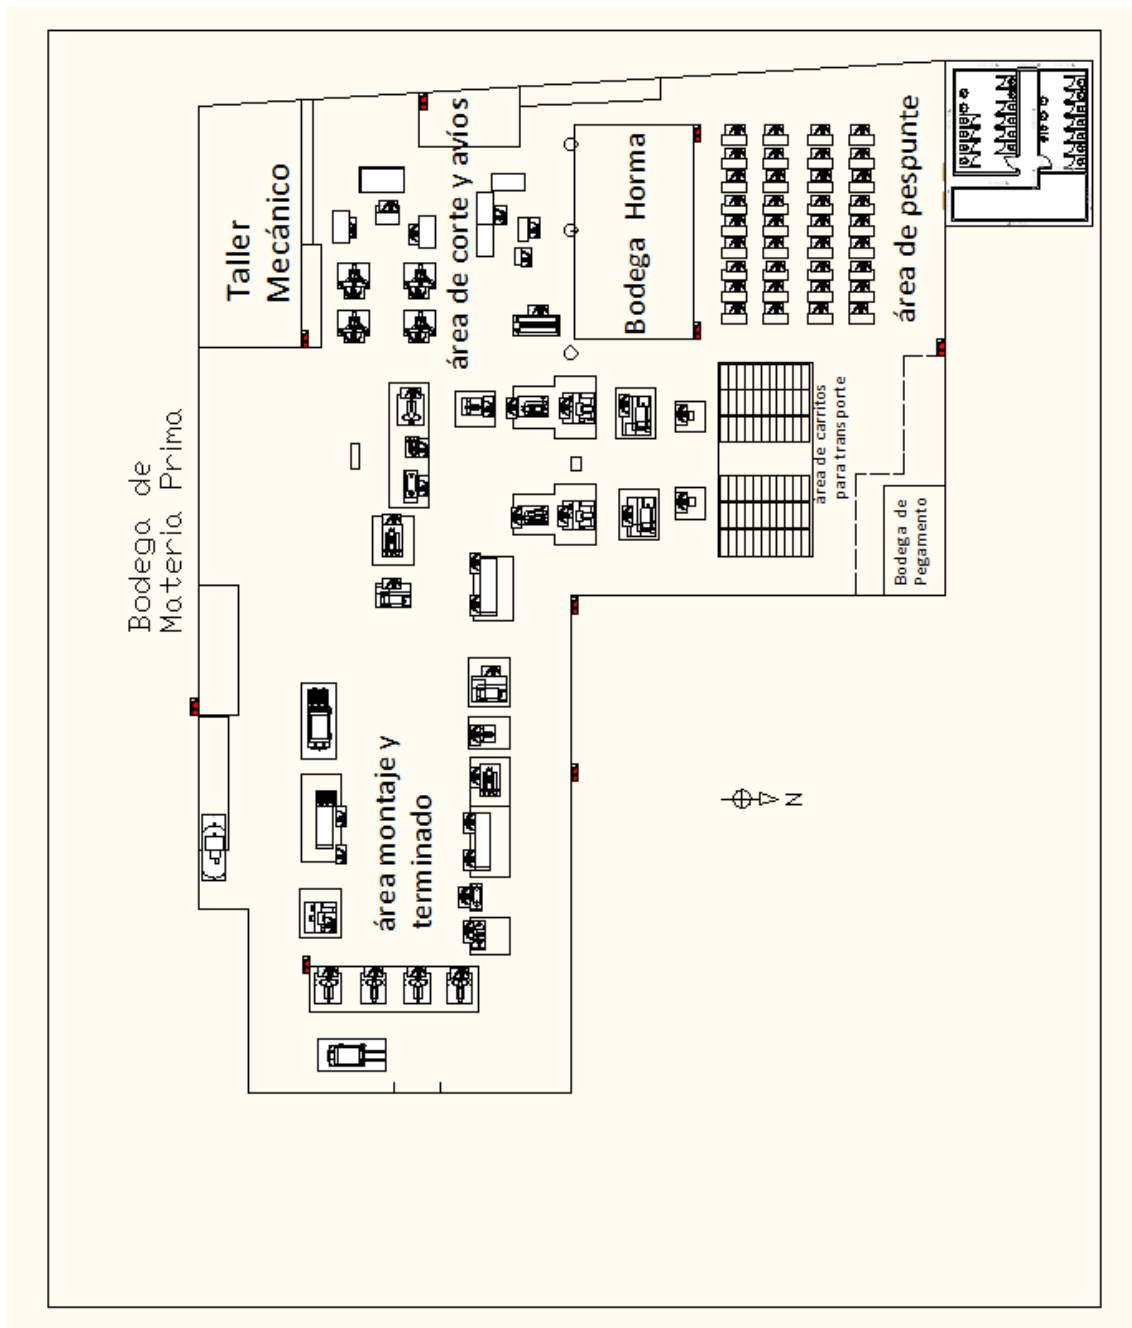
Estructura actual de las instalaciones de la planta de producción de calzado
